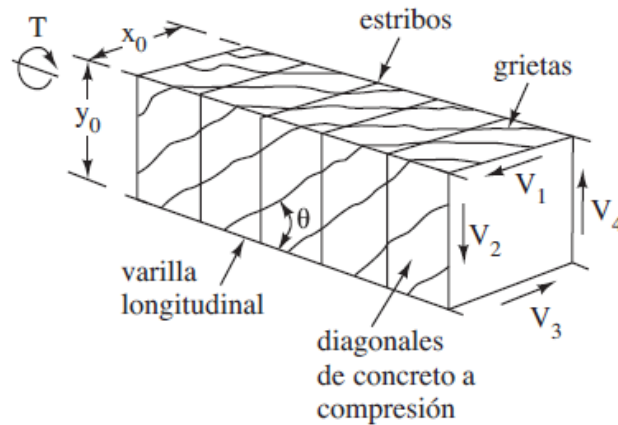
Armadura imaginaria. (Fuente: ACI 318-08)
